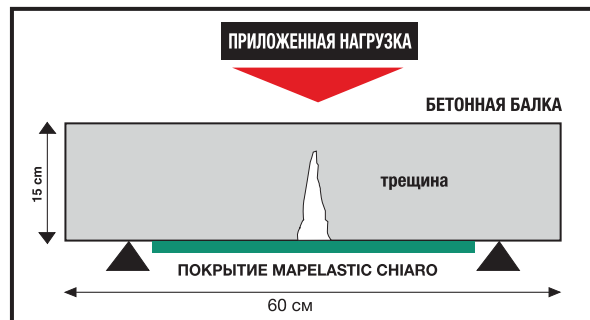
Защита трещины с помощью Mapelastic Chiaro на нижней грани бетонной балки, подверженной изгибающей нагрузке
